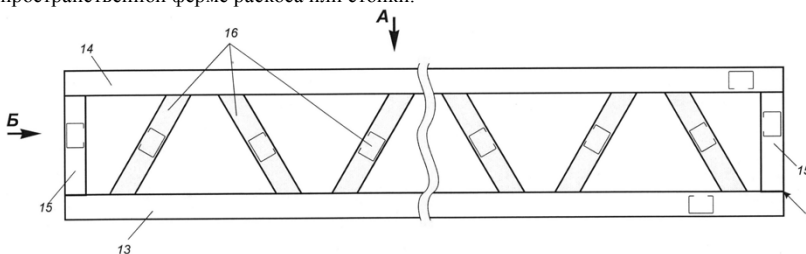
Арматурный каркас в виде пространственной фермы в качестве арматурного каркаса (вид спереди) [4], где: 13 – нижний пояс; 14 – верхний пояс; 15 – соединительные стойки; 16 – соединительные раскосы.
